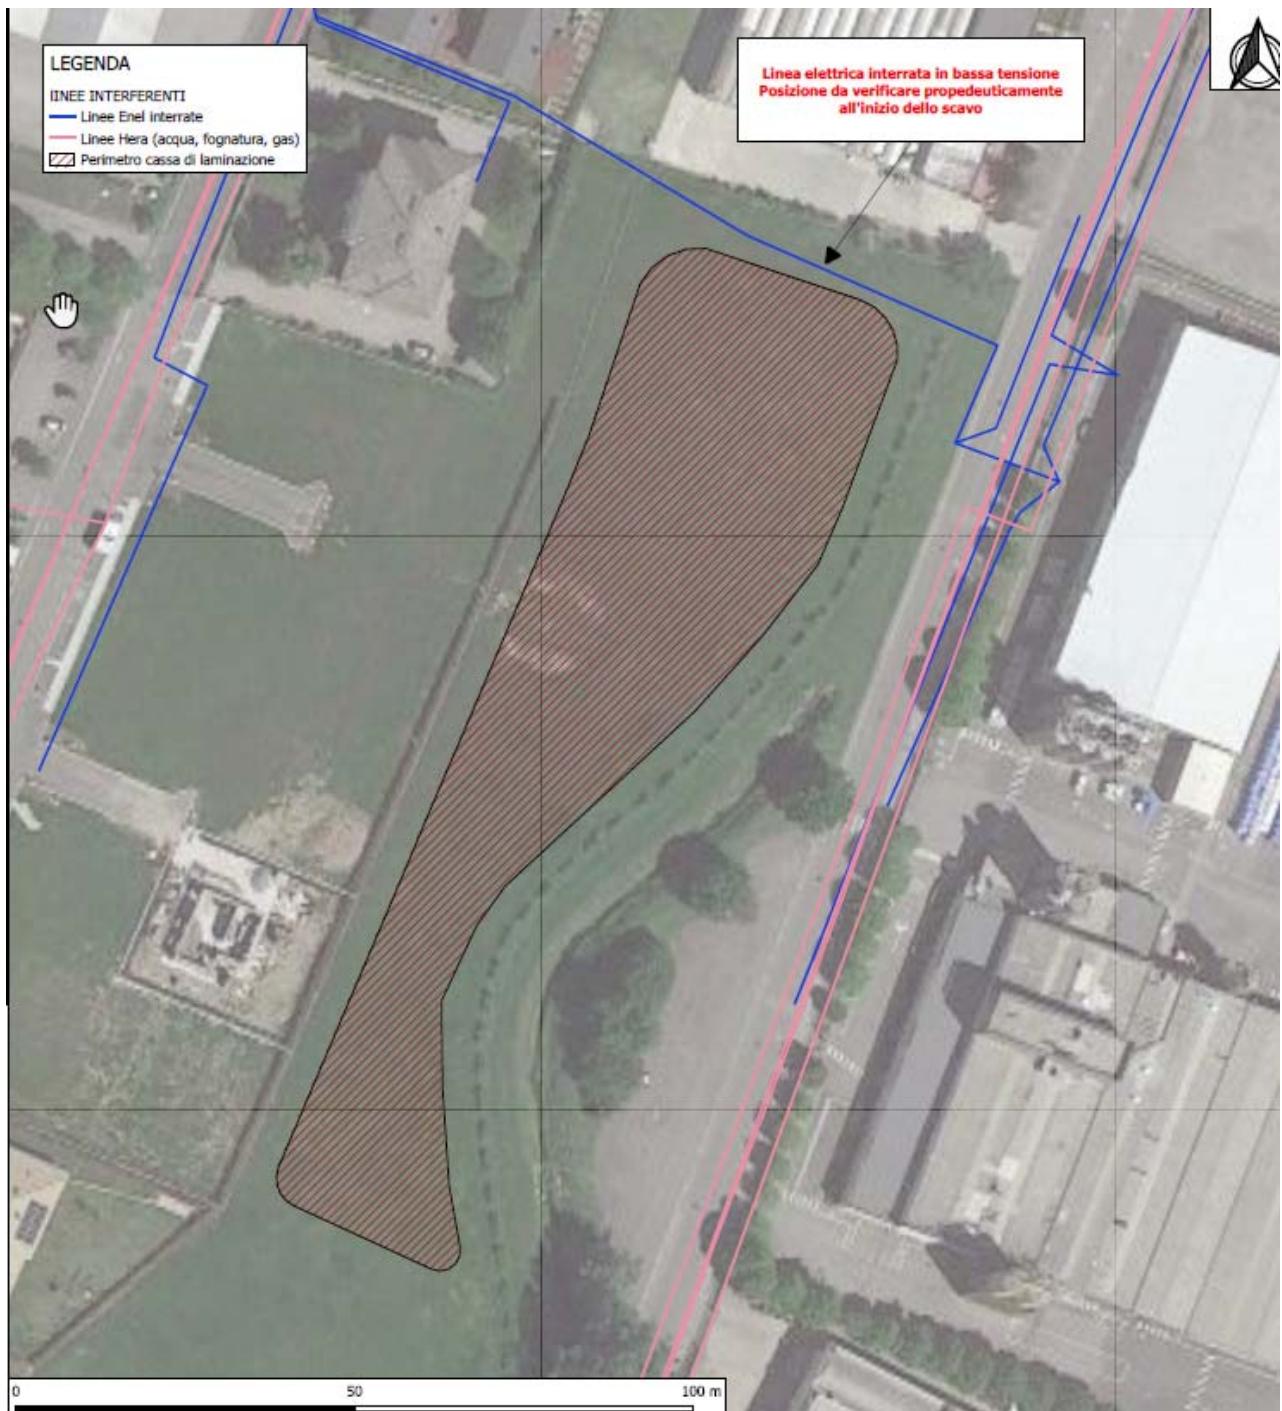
Schematizzazione dell'impianto di laminazione previsto dal Comune (primo stralcio).
